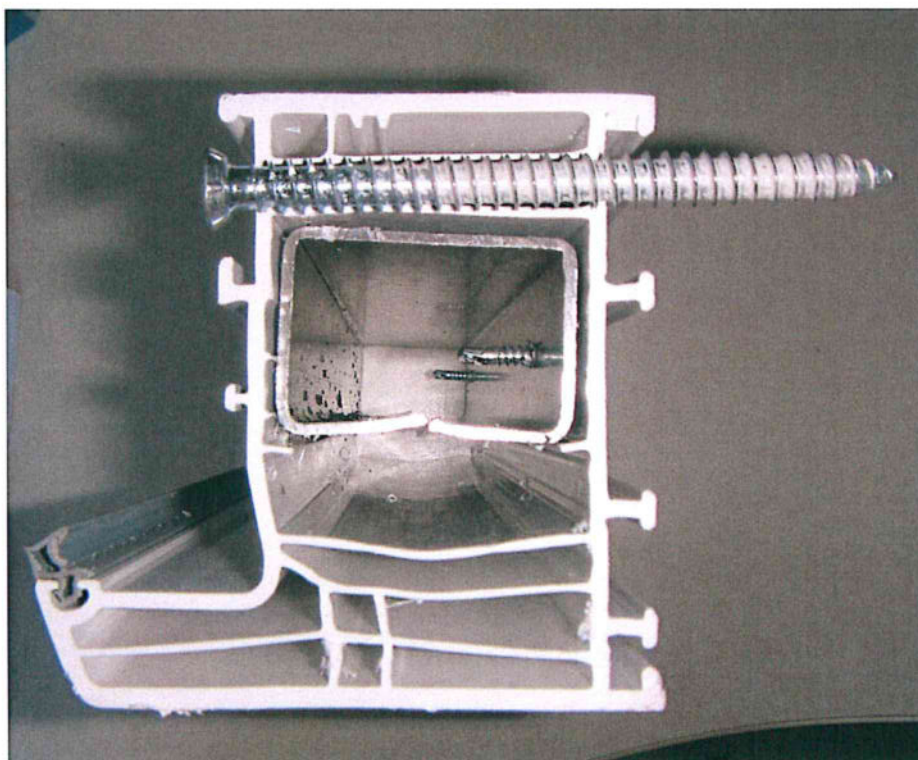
Detail, Fensterrahmenprofil der Firma Inoutic mit Stahlarmierung. Ansicht auf die Verschraubungsachse im Rahmenprofil. Die blaugelb Rahmenfixschraube wird nicht durch die Stahlarmierung geschraubt
